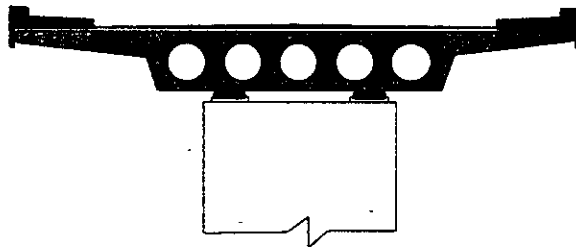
Puente tipo losa extruida o alveolar colada en sitio y postensada
